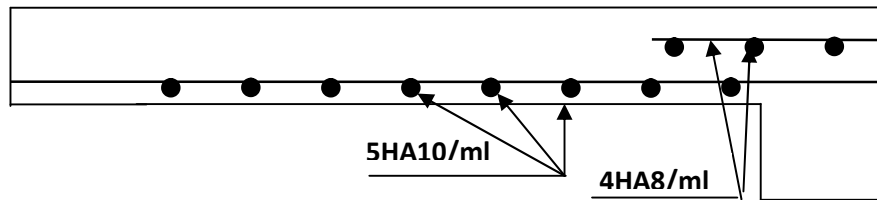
Schéma de ferrailage de troisième type de balcon.
